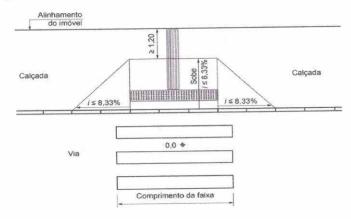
Rebaixamentos de calçada - Vista superior (Norma NBR 9050).
